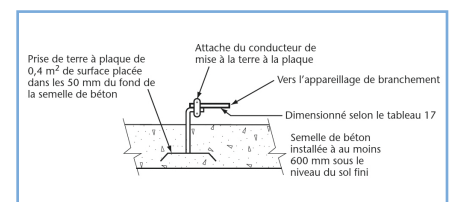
Prise de terre à plaque dans la semelle de béton de la fondation (extrait du Guide explicatif du CCÉ 2010)
